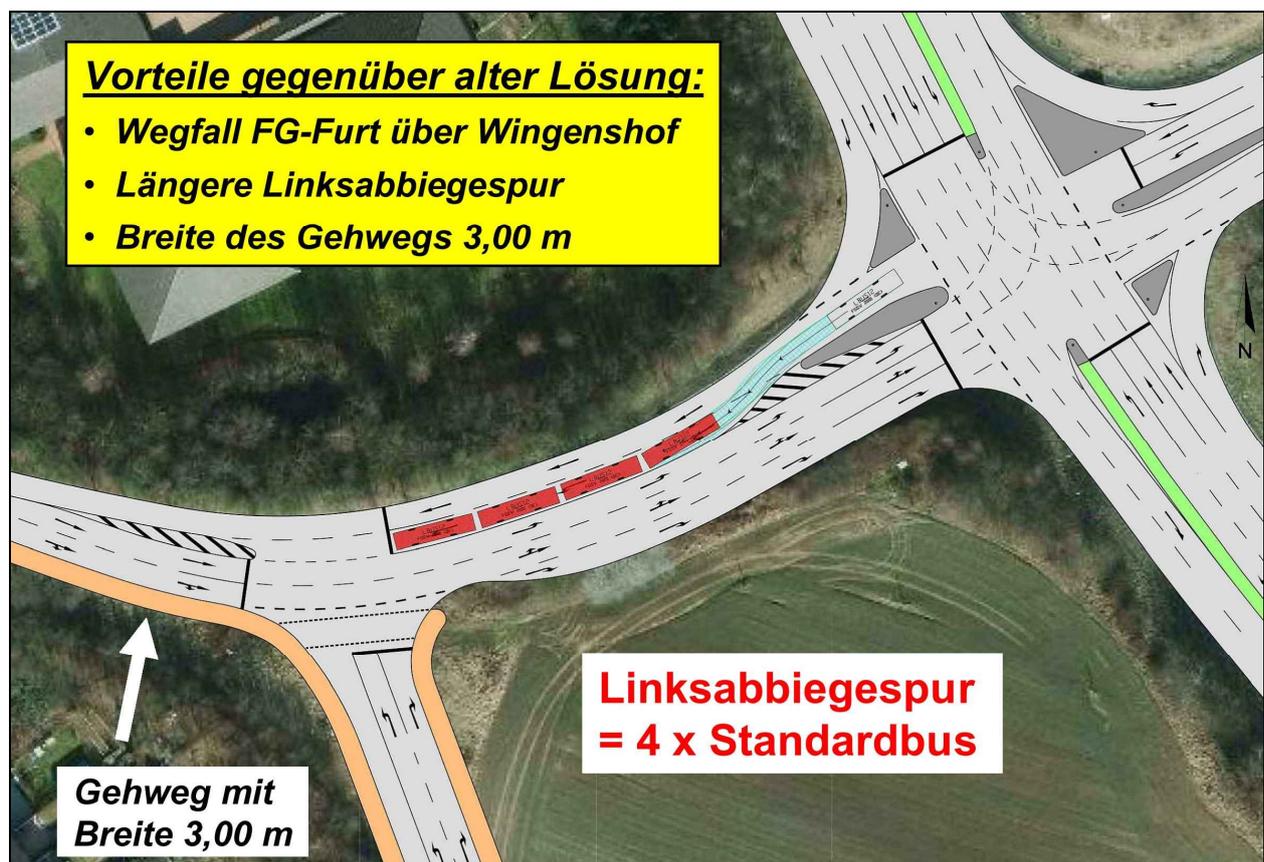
Lageplan der Anbindung an den Wingenshof mit Darstellung der relevanten Planungsdetails
